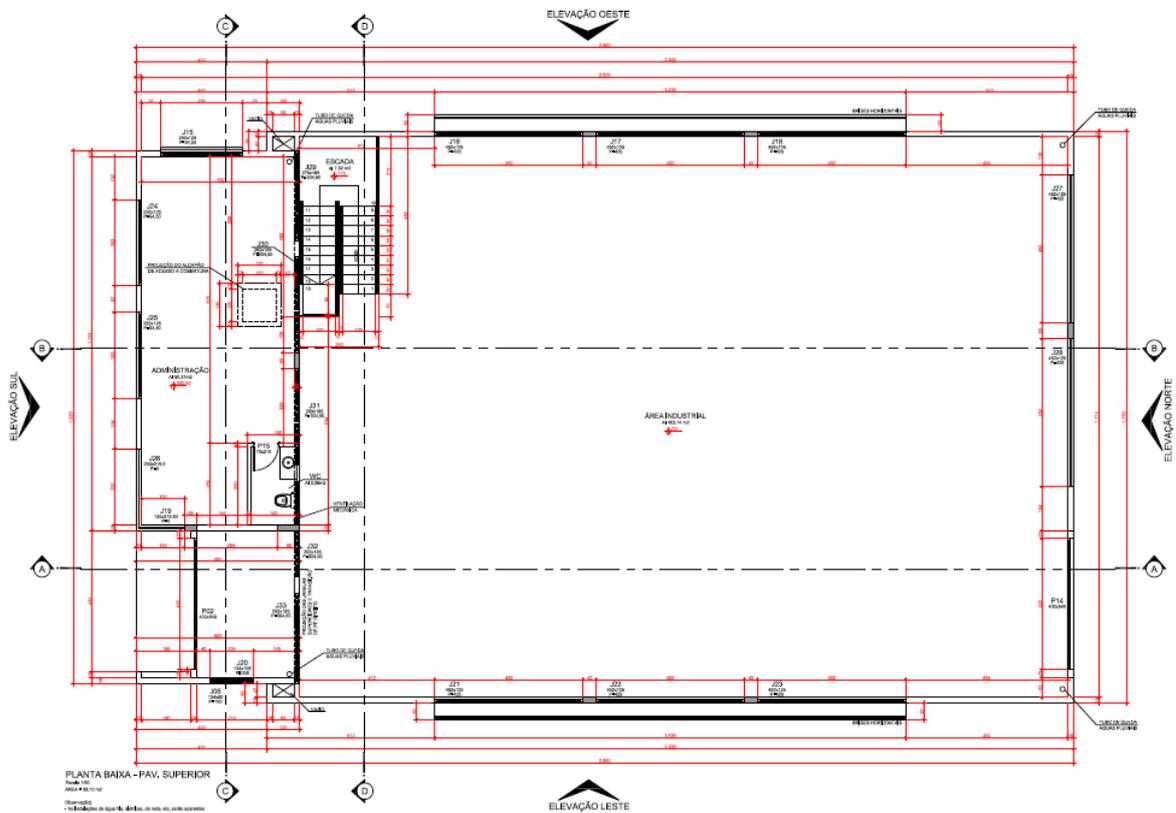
Planta baixa – pav. Superior (mezanino) – área 58,10m<sup>2</sup>
